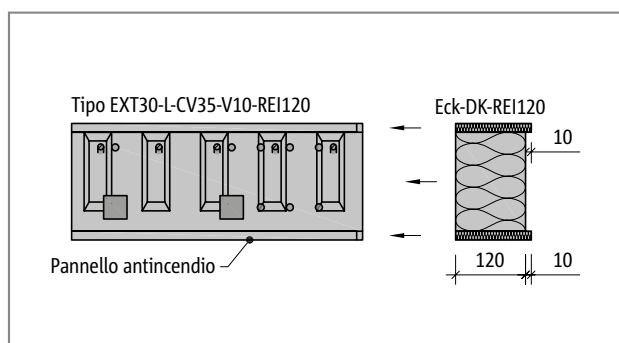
Schöck Isokorb® tipo EXT30-L-CV35, REI120: Vista dell'elemento
